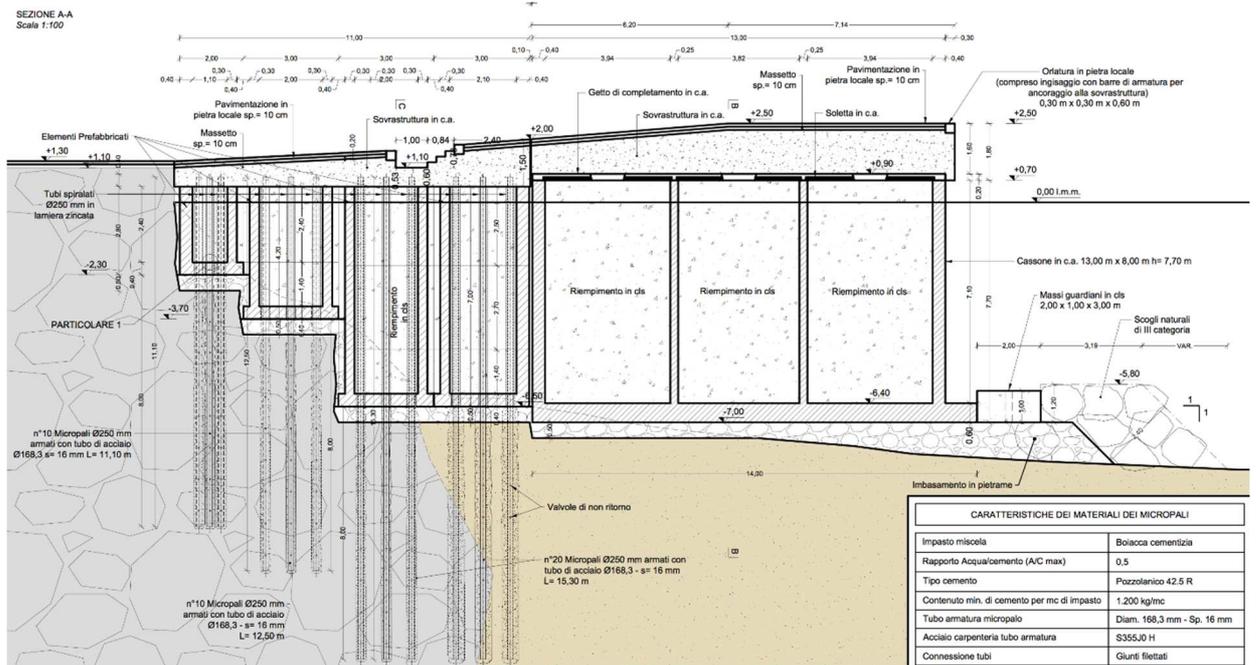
Sezione longitudinale estratto da 2017E037INV-02-D-OM-TAV002
